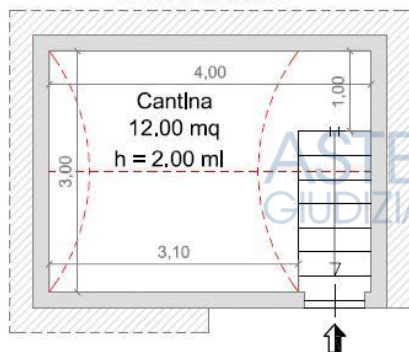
Planimetria Catastale Abitazione e Cantina Piano Interrato.
